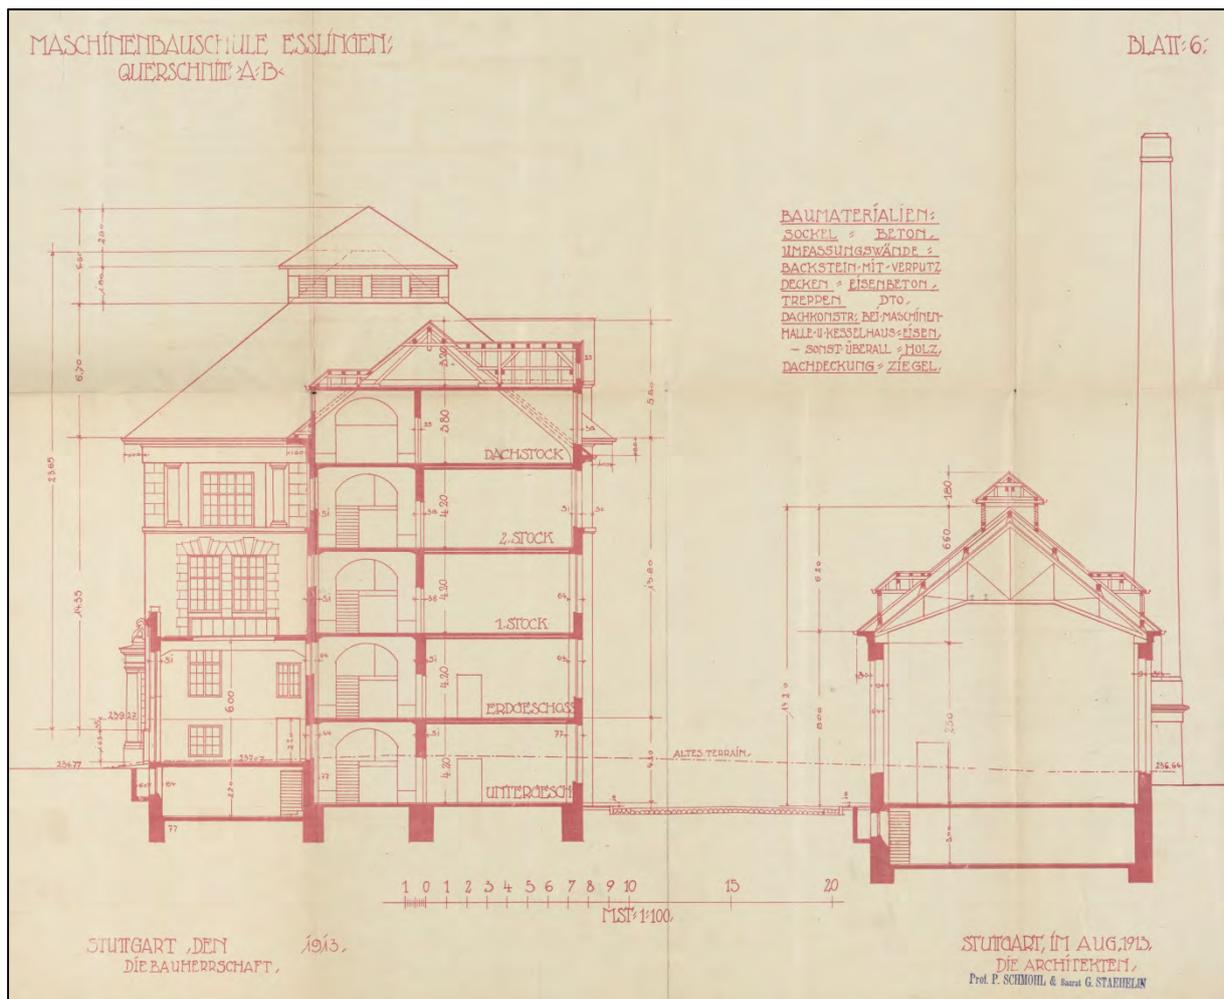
Bauplan – Querschnitt AB (Neubau Maschinenbauschule 1913)
